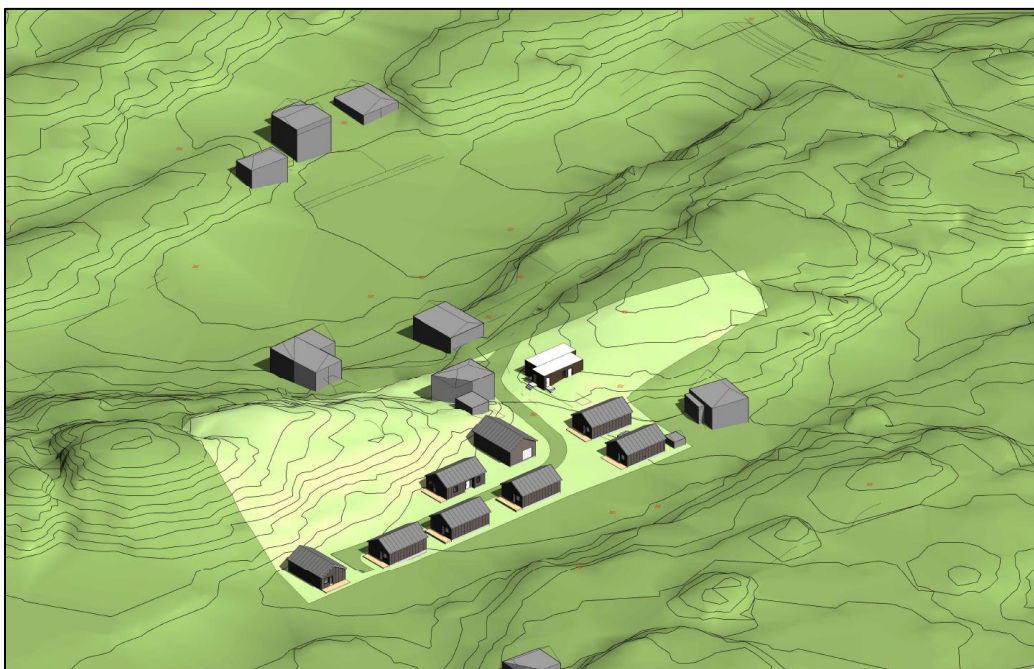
Eksteriørskisse av planlagt bebyggelse, alt. A
